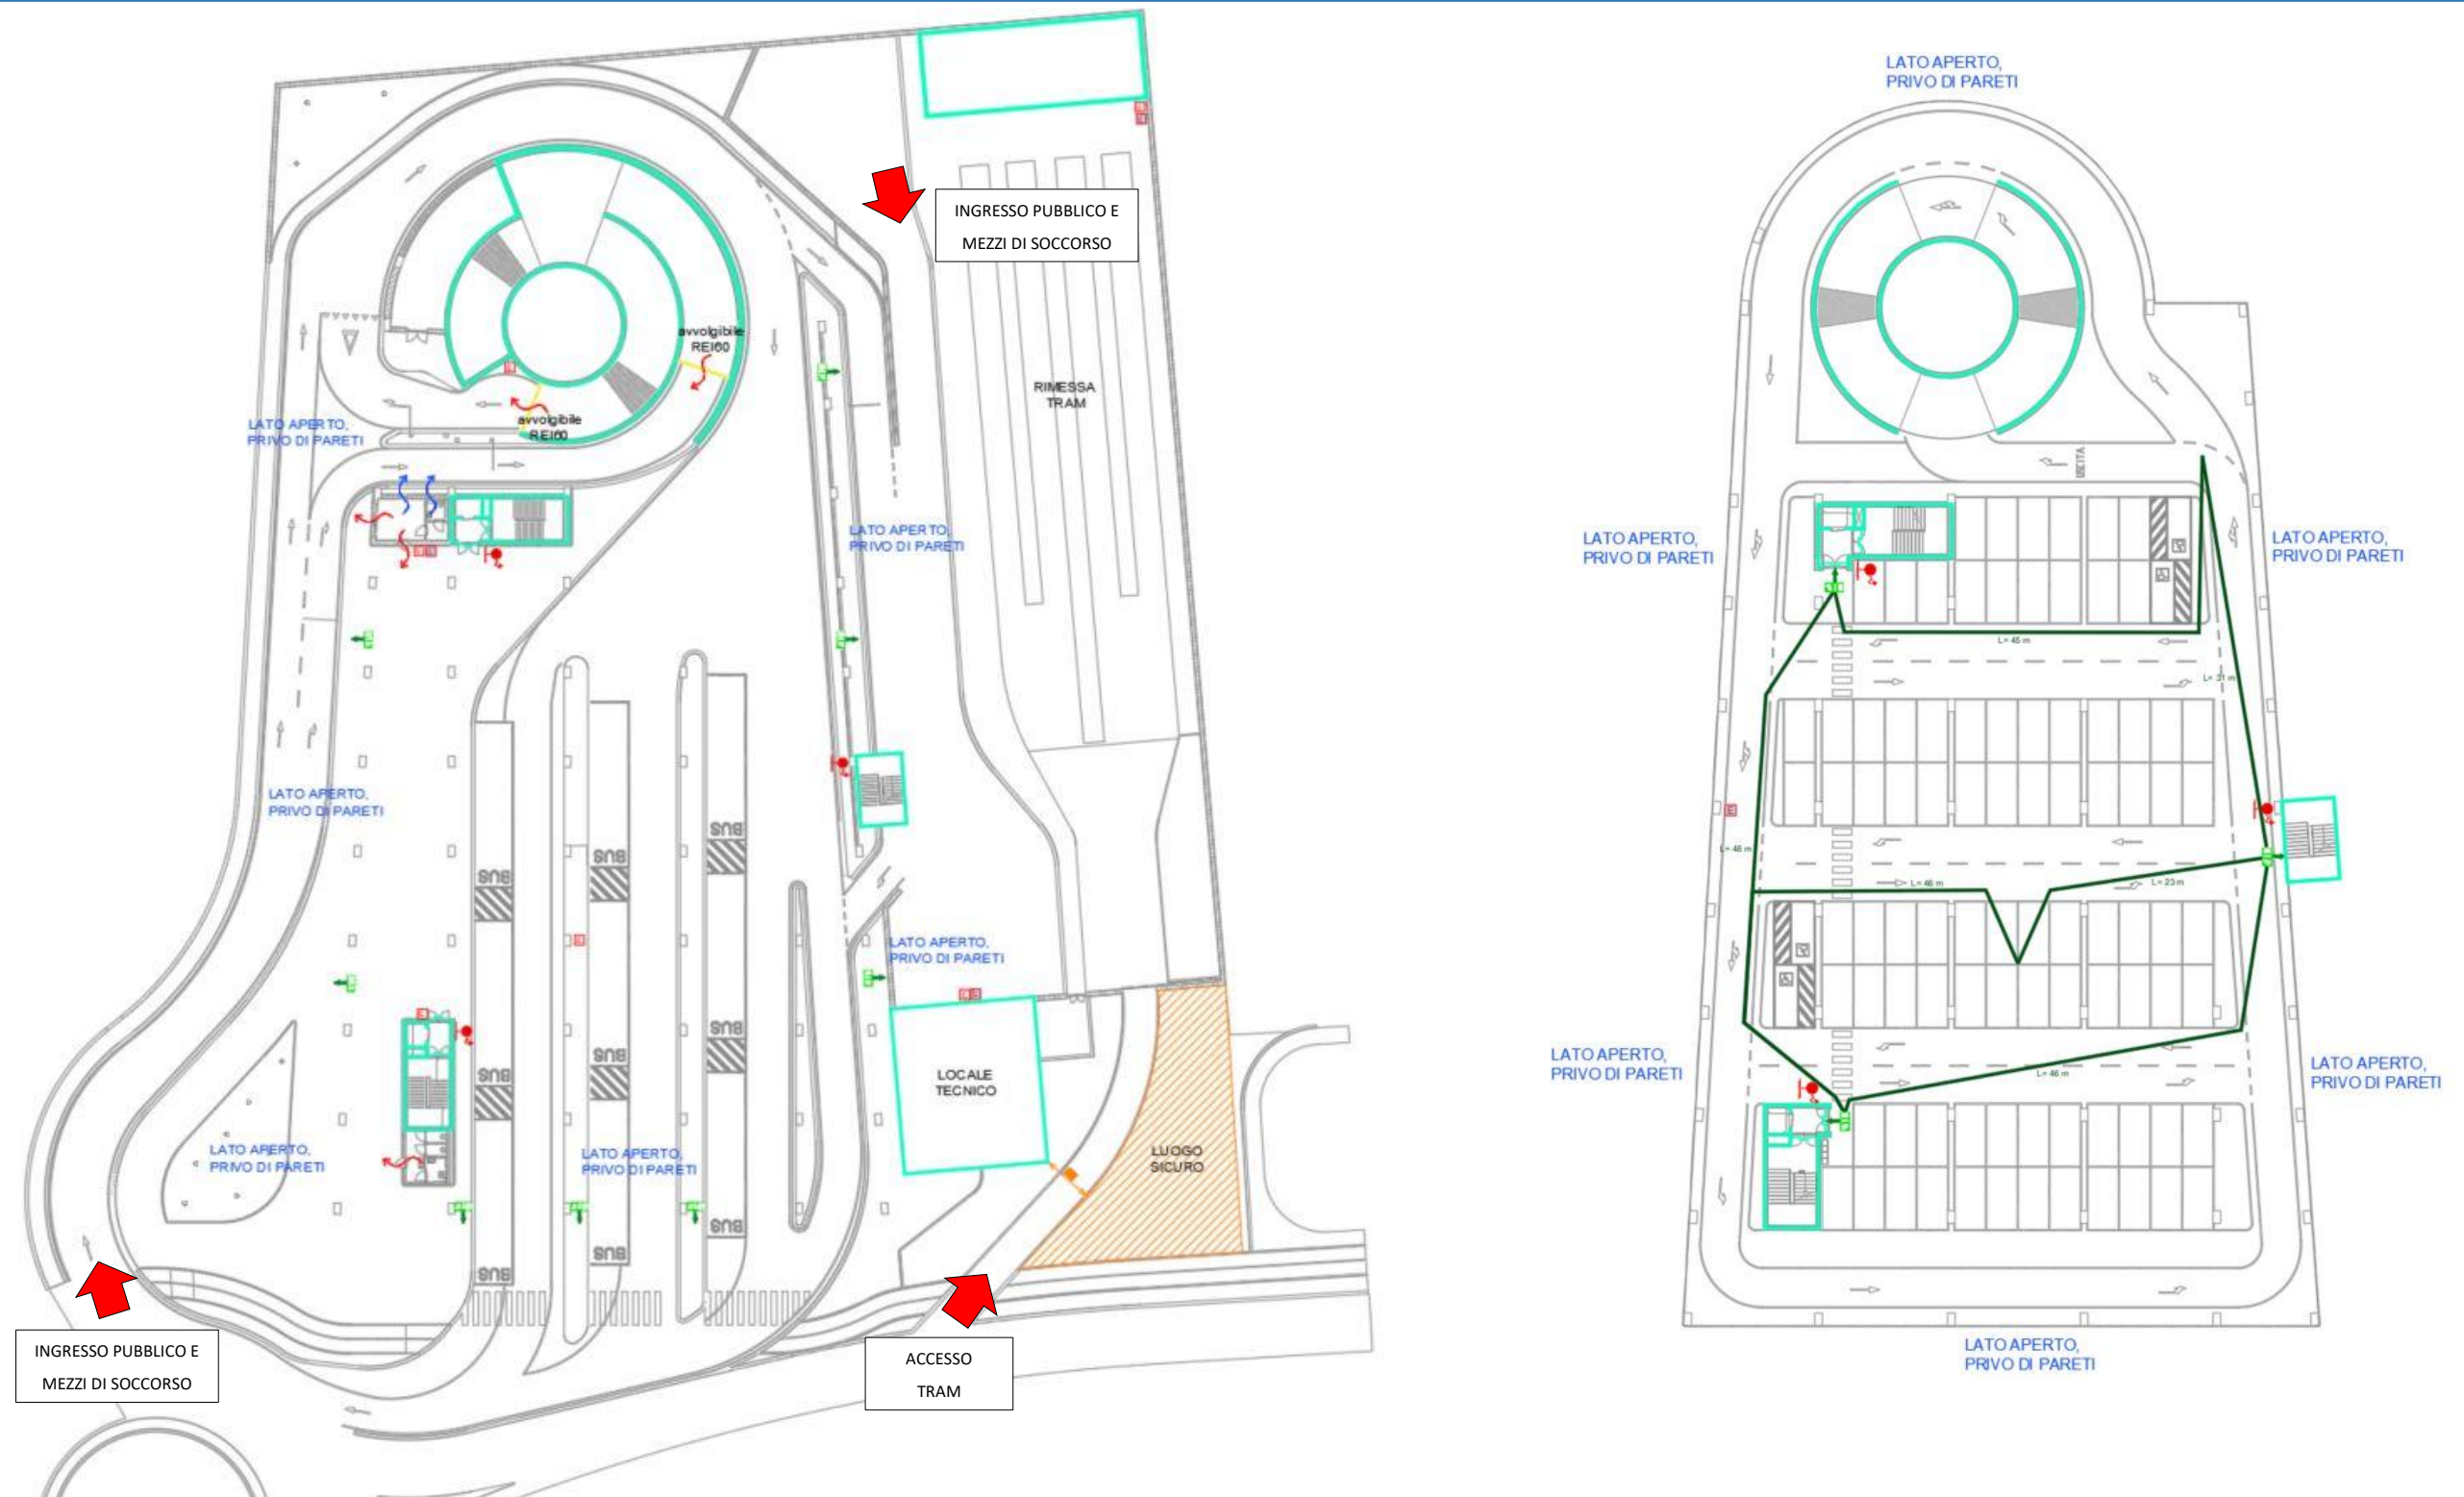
Pianta Piano Terra e Piano Tipo Parcheggio nodo di interscambio
